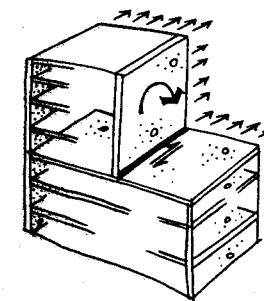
Уступы, включающие диафрагмы, могут искажать траекторию передачи нагрузок на конструкцию фундаментов
